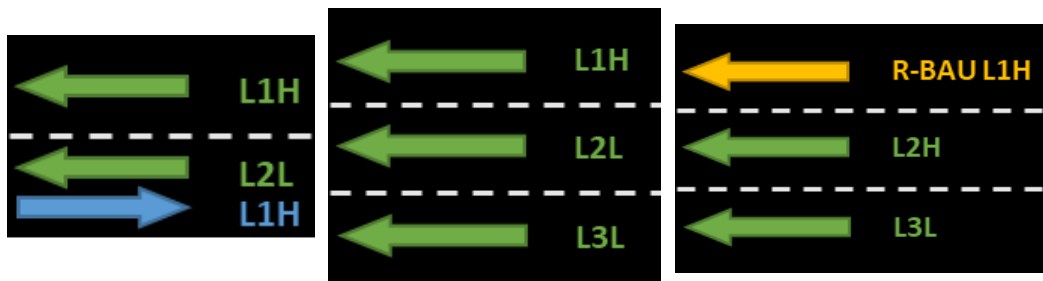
43 Configurations de chaussée étudiées pour les poutres P1 et P2 des ponts multipoutres
